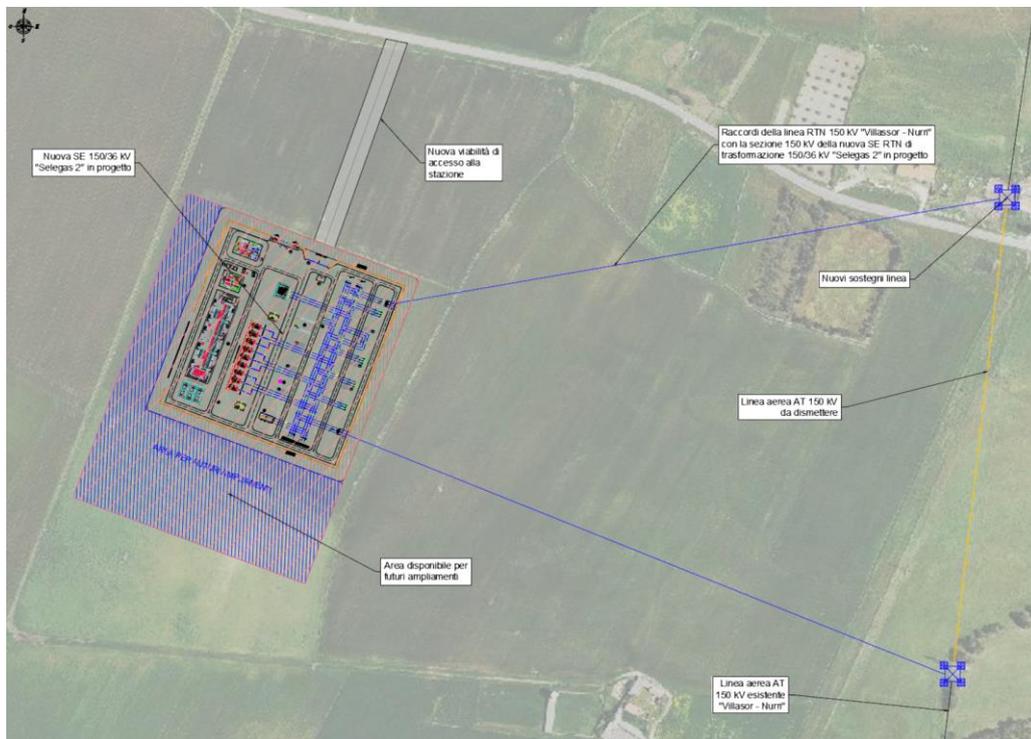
Area SE RTN con sezione 150/36 kV
